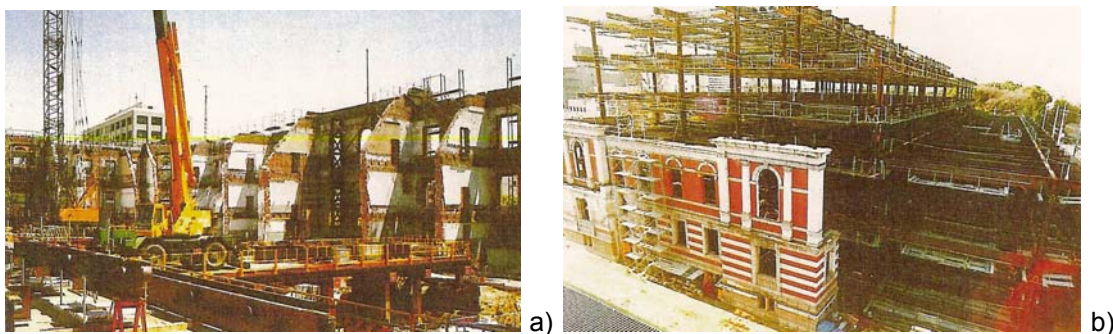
Estabilização das paredes com estrutura metálica e construção da nova edificação com estrutura metálica. a) Vista Interna b) Vista Externa
